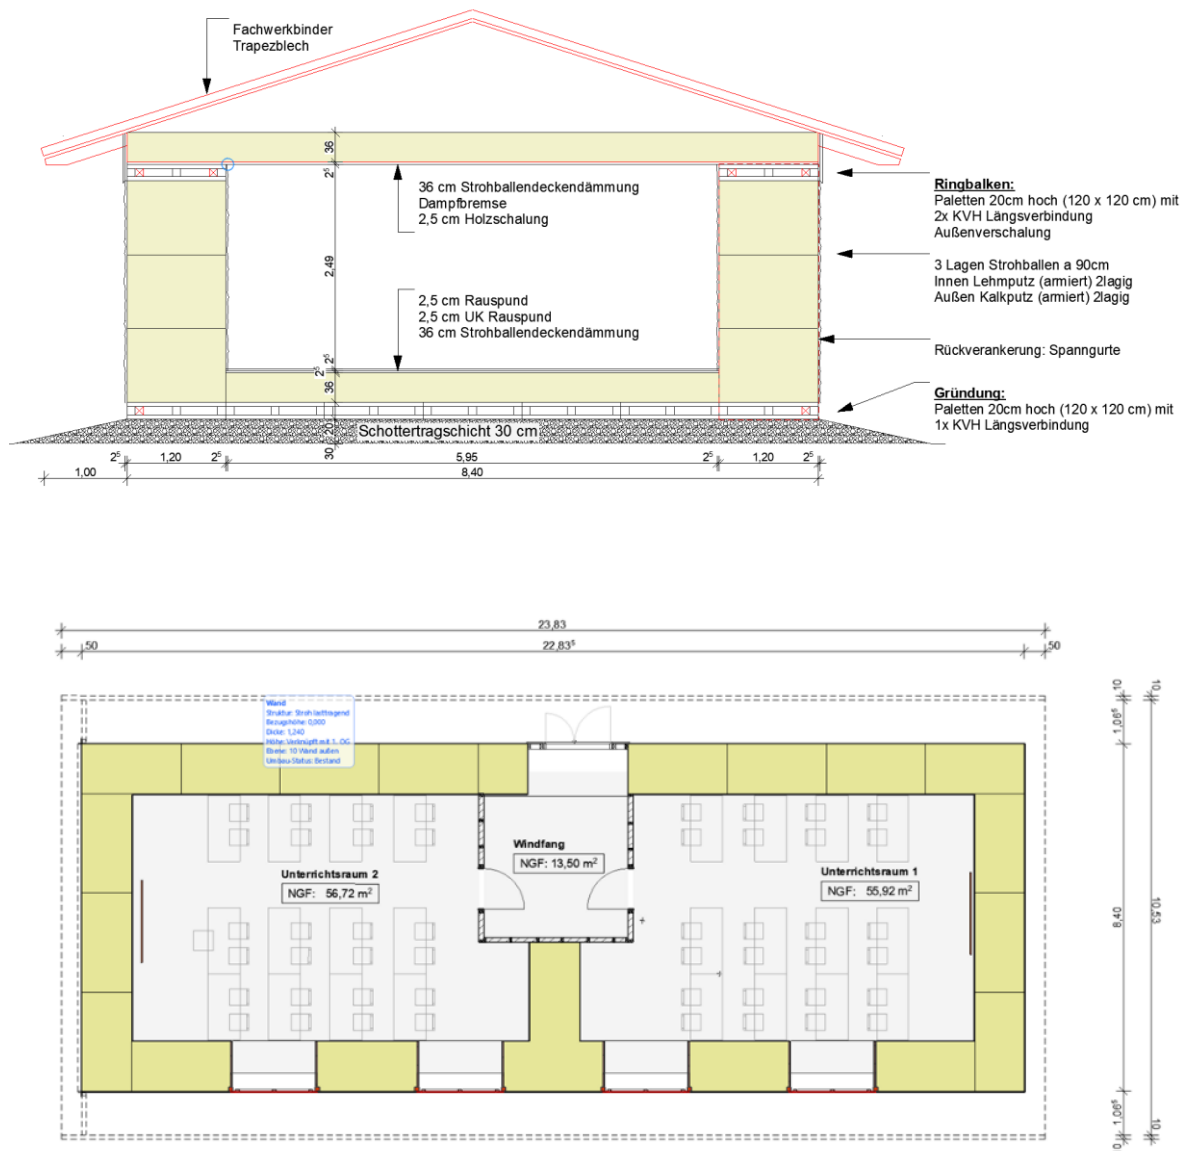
Strohklassenzimmer in Holzdorf: Grundriss und Querschnitt (Quelle: Z-Architektur)
